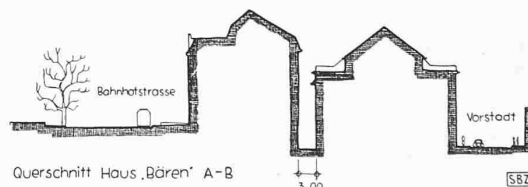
Profil A-B zu untenstehendem Block, 1:1250
